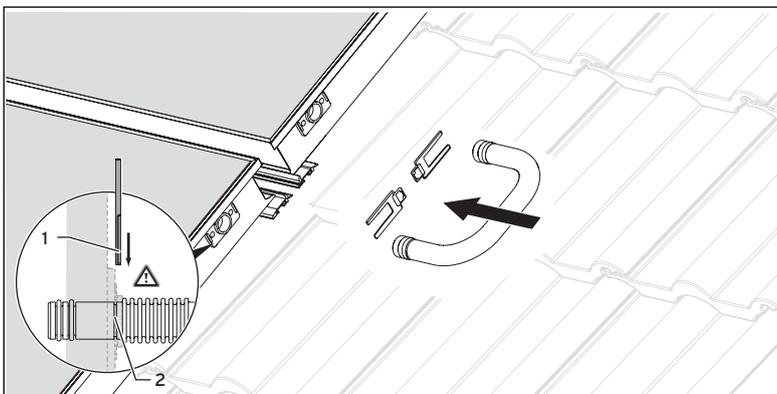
Collegamento dei collettori (disposizione sovrapposta del campo)
